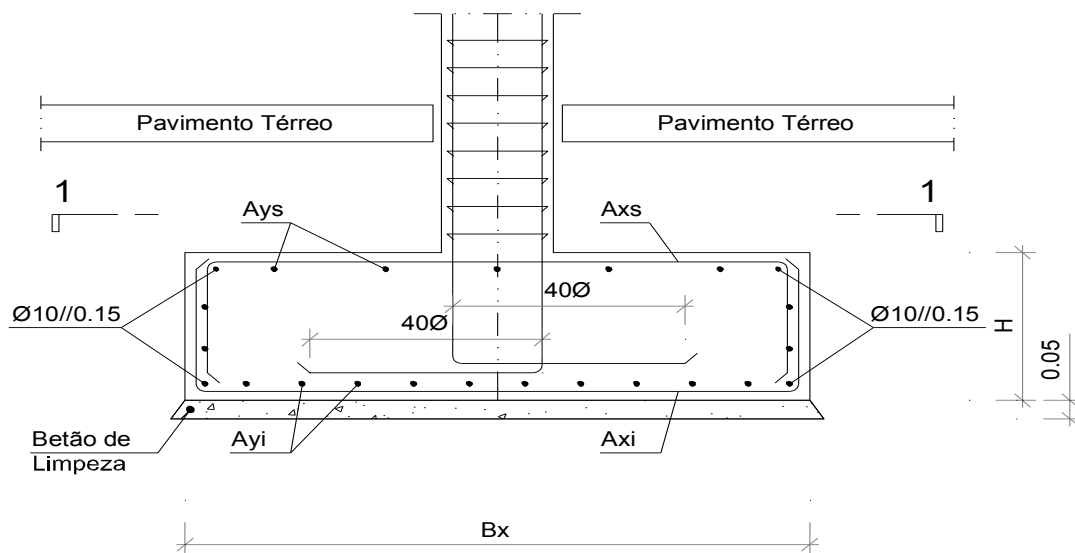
DESENHO DO CORTE DA SAPATA EM PLANTA (AUTOCAD)
